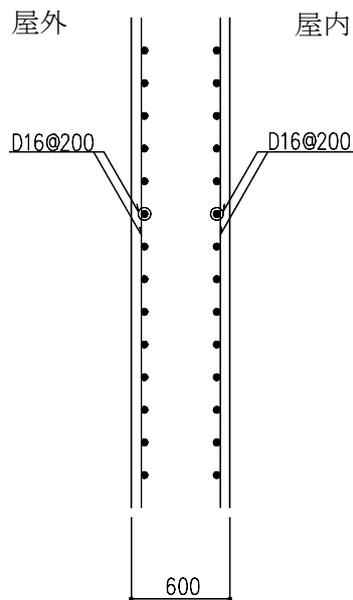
耐震壁の配筋図 (1階, YM通り X1~X2通り間) (単位: mm)
